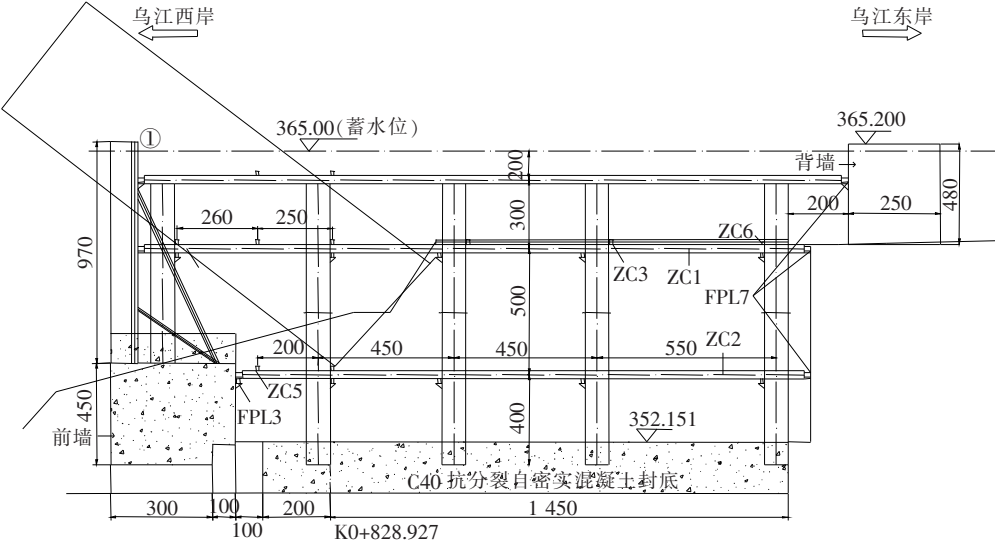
东岸拱座围堰立面图(单位:除标高为 m 外,其余:cm)
